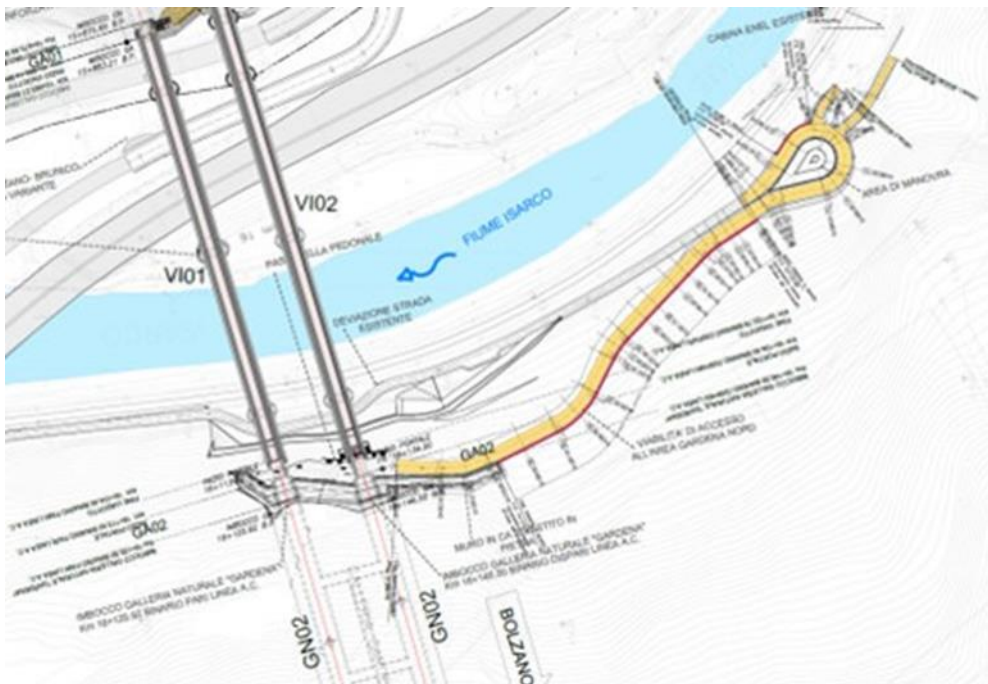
2-Planimetria viabilità accesso Gardena nord NV061
